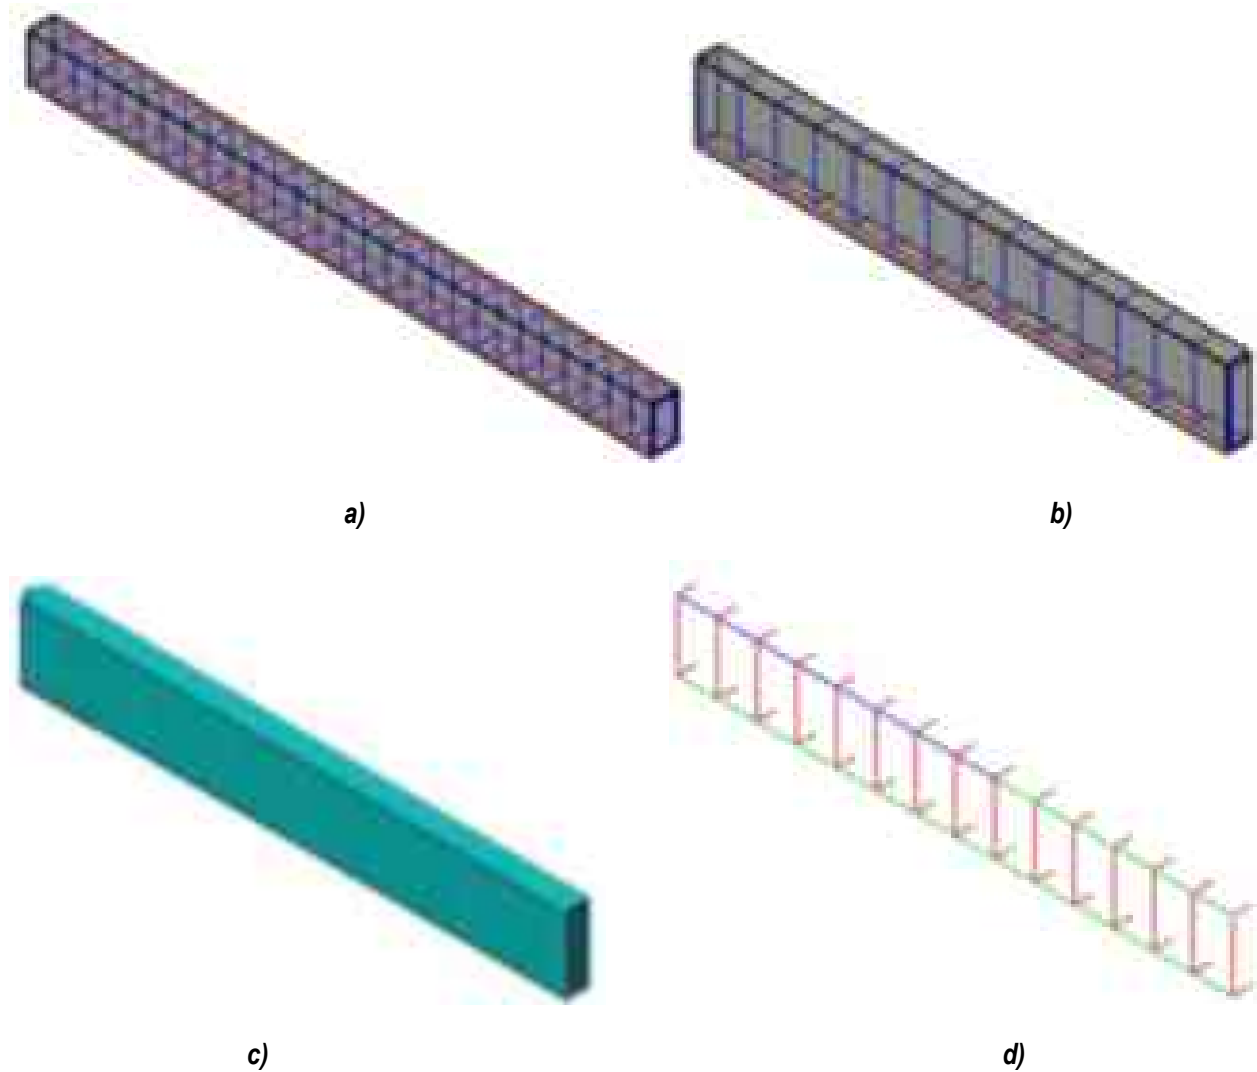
Modelo tridimensional de la viga V-1 de concreto reforzado: a) viga completa, b) modelado de  $\frac{1}{4}$  de viga, c) mallado en midas FEA y d) mallado del acero de refuerzo
